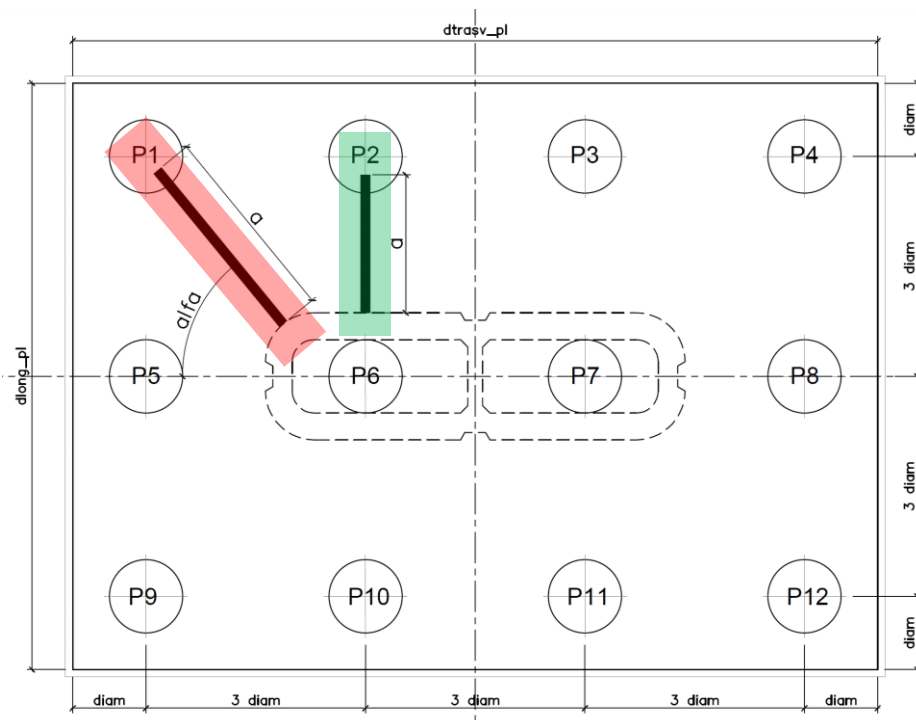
Vista in pianta - Tirante-puntone longitudinale (verde) e diagonale (rosso)
